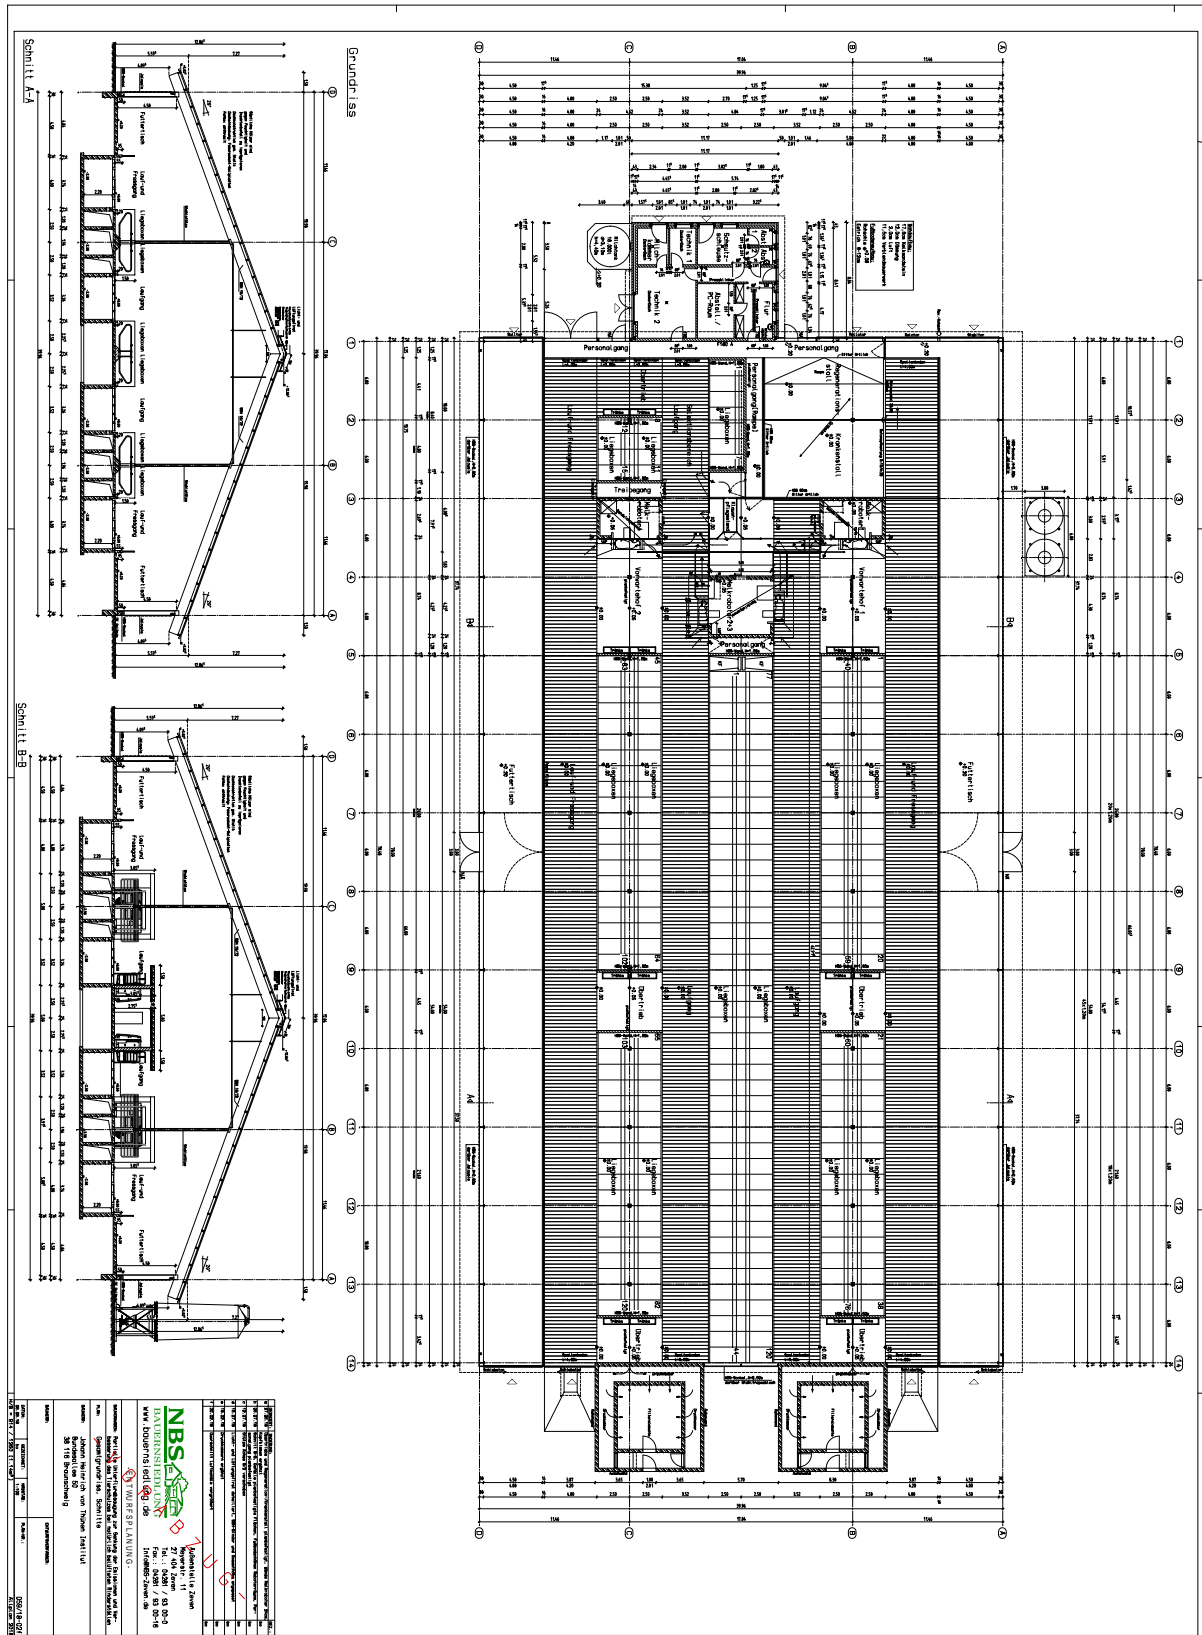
Grundriss und Schnitt Stallgebäude Version 08
